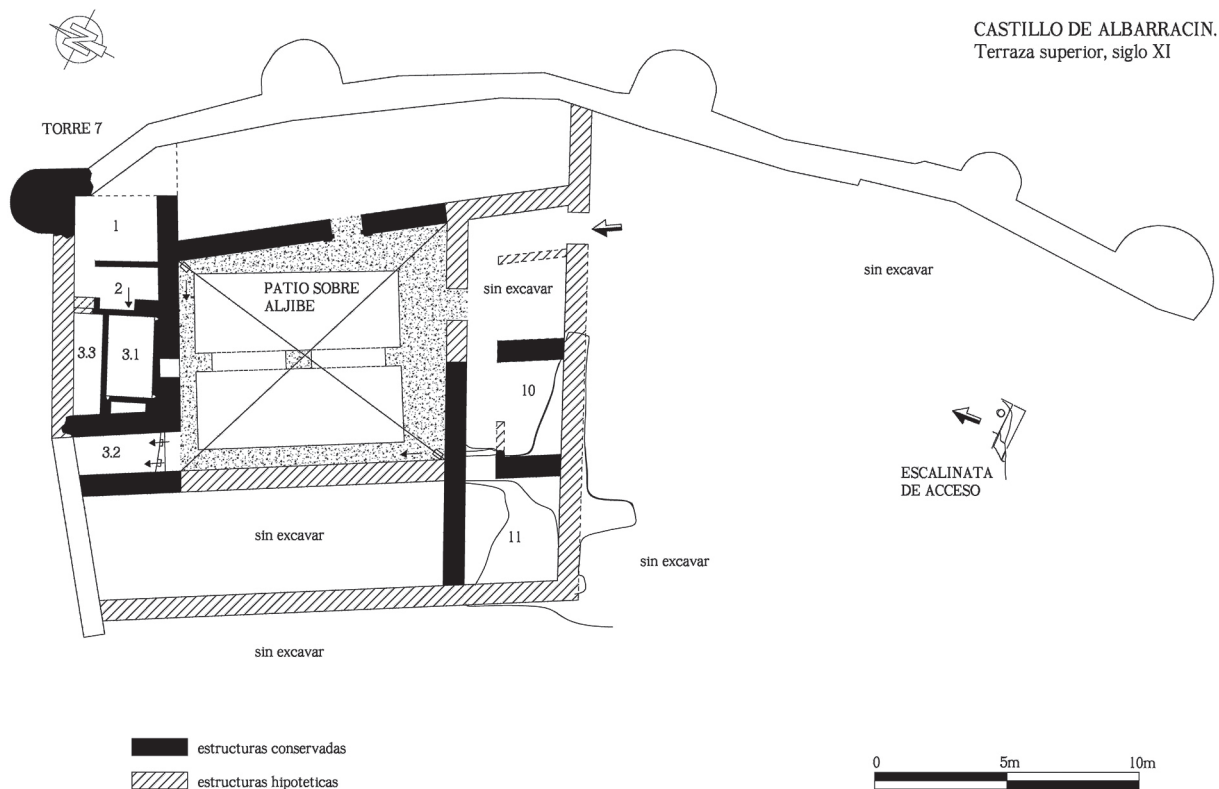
Planta con las estructuras documentadas en la zona alta, período 8.
